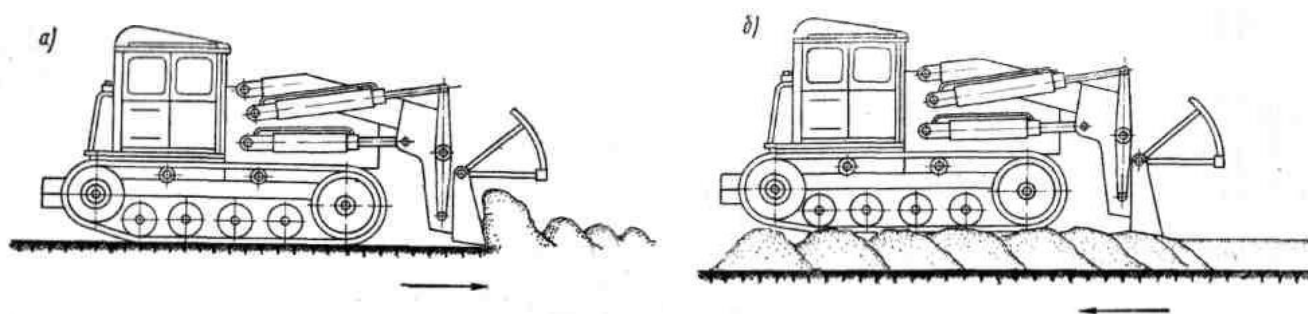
Планування ґрунту навантажувачем, обладнаним двощелепним ковшем:
